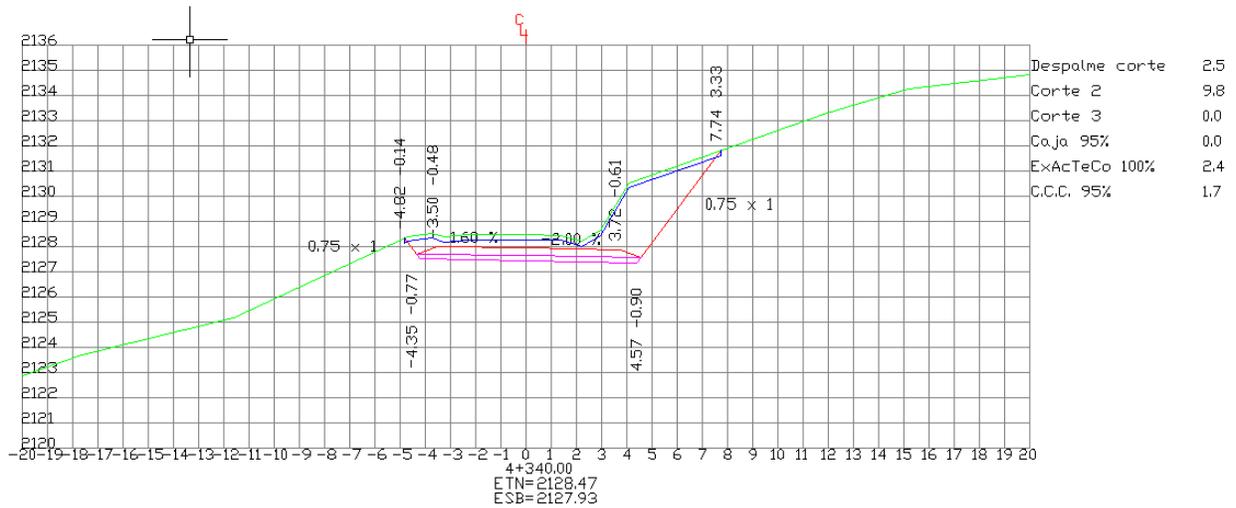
Sección transversal, km 4+340, en zona donde se requiere defensa metálica lado izquierdo.
